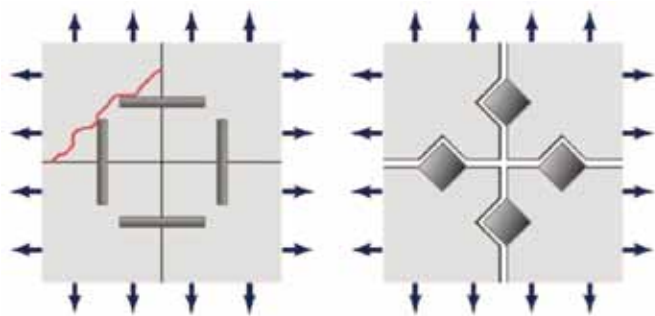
Barras pasadoras tradicionales redondas colocadas demasiado cerca de una intersección de juntas pueden provocar roturas de esquina debido a las tensiones de restricción; la libertad de movimientos laterales con pasadores placa diamante puede mitigar las tensiones de restricción.
